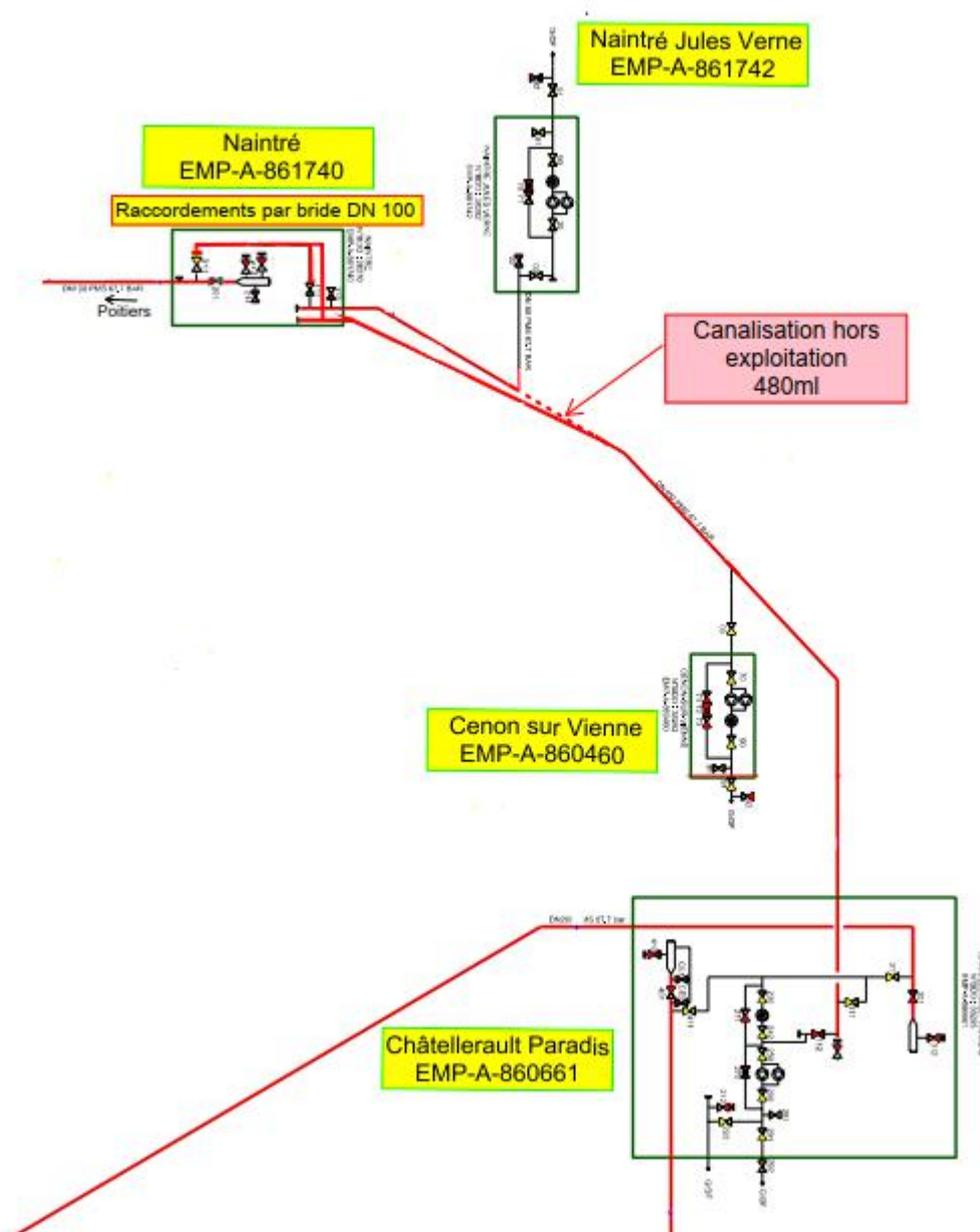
Schéma d'armement de l'ouvrage, après restructuration
